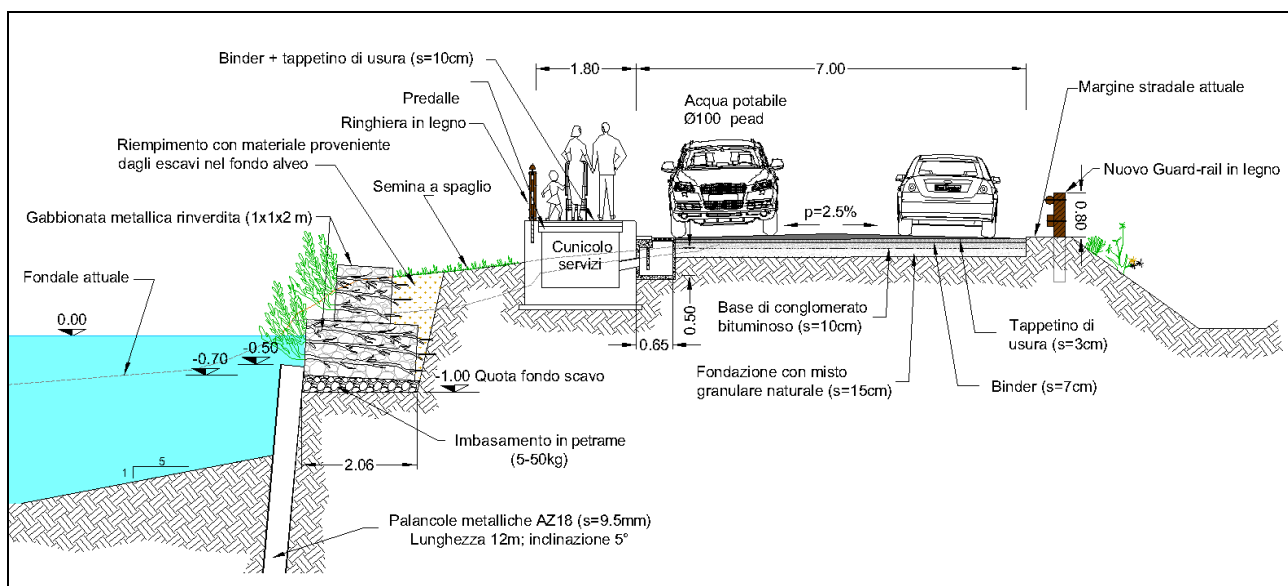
Sezioni tipo della sistemazione stradale prevista nel Progetto Esecutivo
